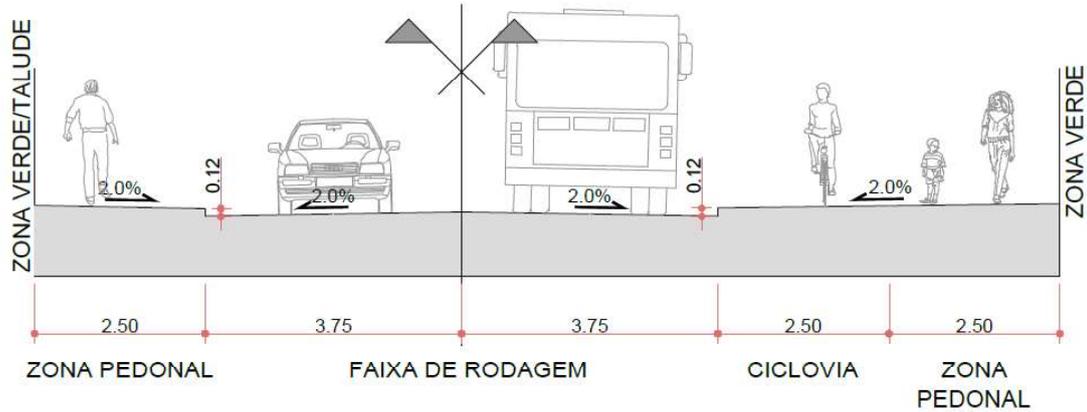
Perfil transversal da via principal do PPT. Solução 1 (AutoCad).
